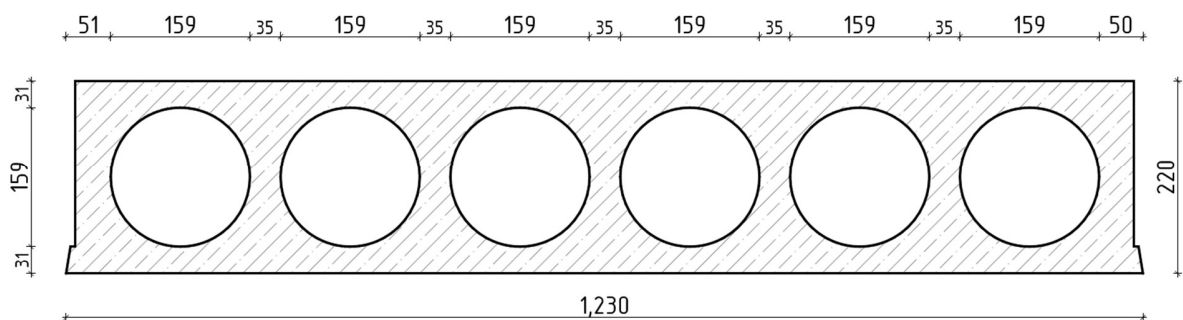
Поперечний переріз багатопустотної плити перекриття
